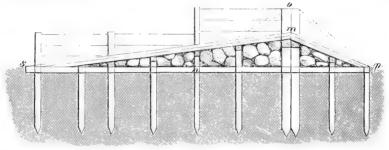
Stauwehr mit eingeschnittener Flofgaffe.
